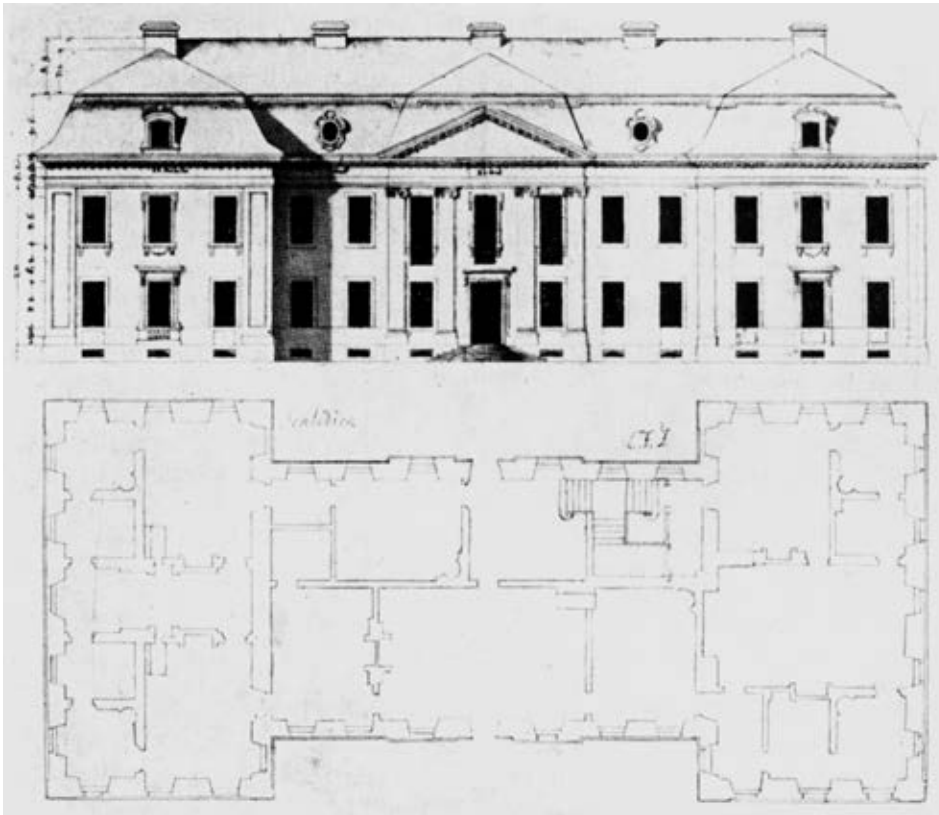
Entwurfszeichnung für den Neubau des Schlosses Schlodien, Grundriss des Erdgeschosses und Aufrissvarianten der Hoffassade. Carl Florus zu Dohna (Sign. »C.F.D.«), Kopie nach einem Plan von Jean de Bodt, nach 1701. Lavierte Federzeichnung. Ehemals Schloss Schlodien, Archiv (ex: FOELSCH 2014, 211)
